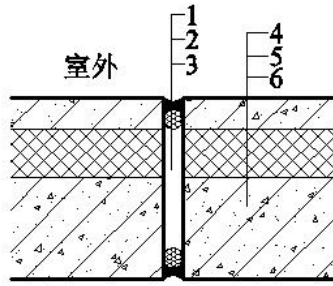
预制混凝土夹心保温外挂墙板竖向接缝防水构造
